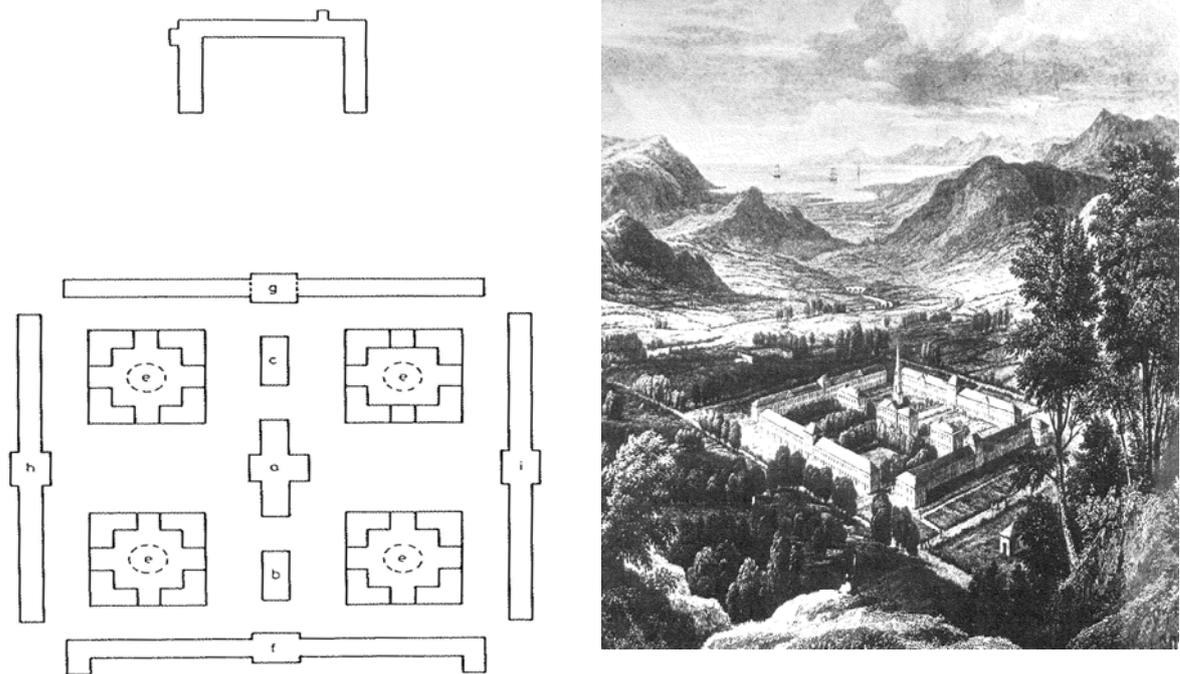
Grundriss einer Village of Unity (l)
